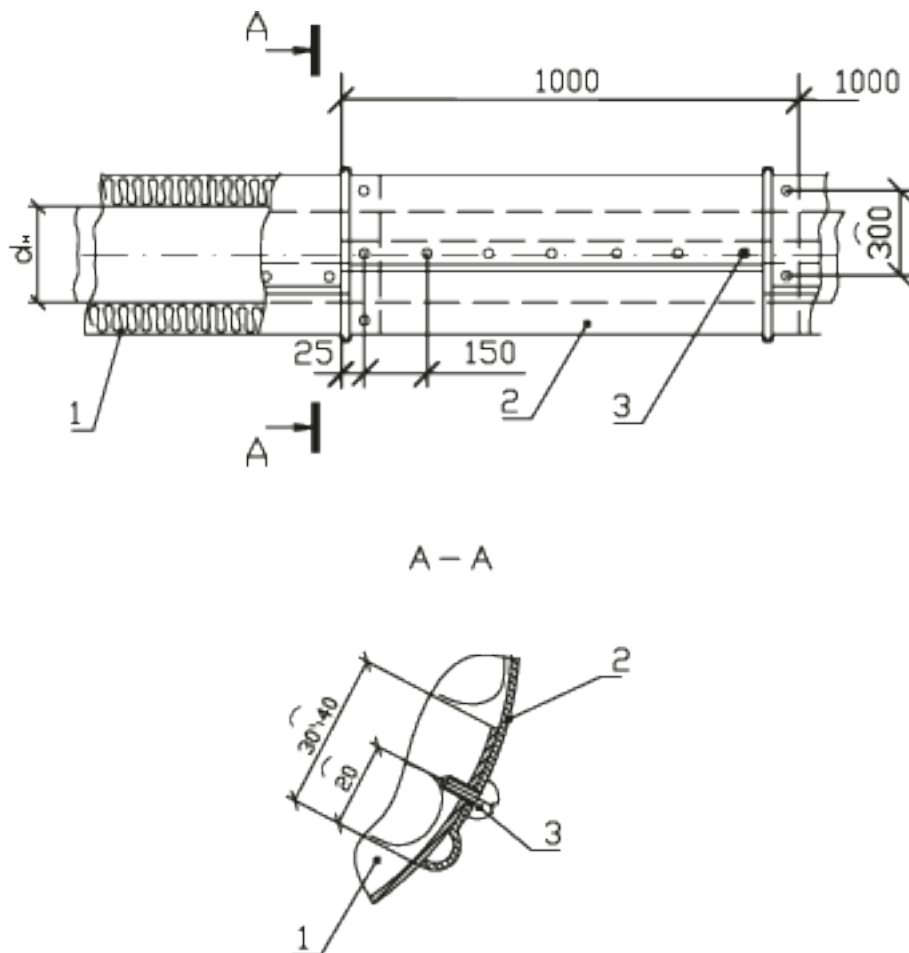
Крепление покрытия изоляции трубопроводов бандажами
